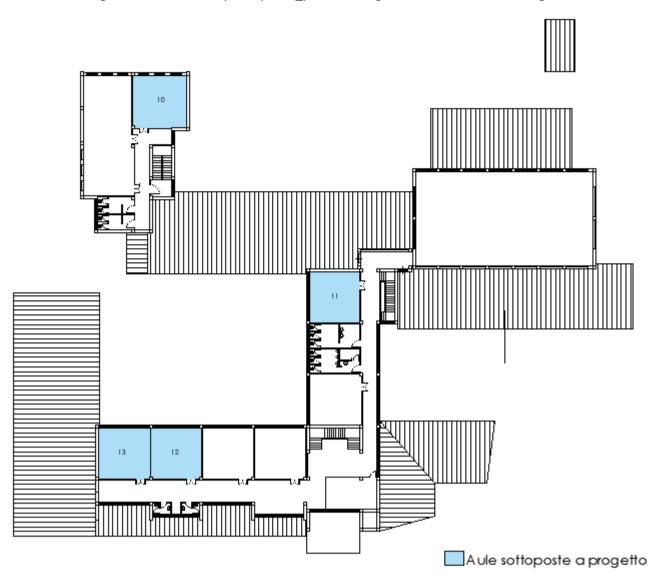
Planimetria generale piano primo\_plesso di via Ferrentino, scuola primaria
